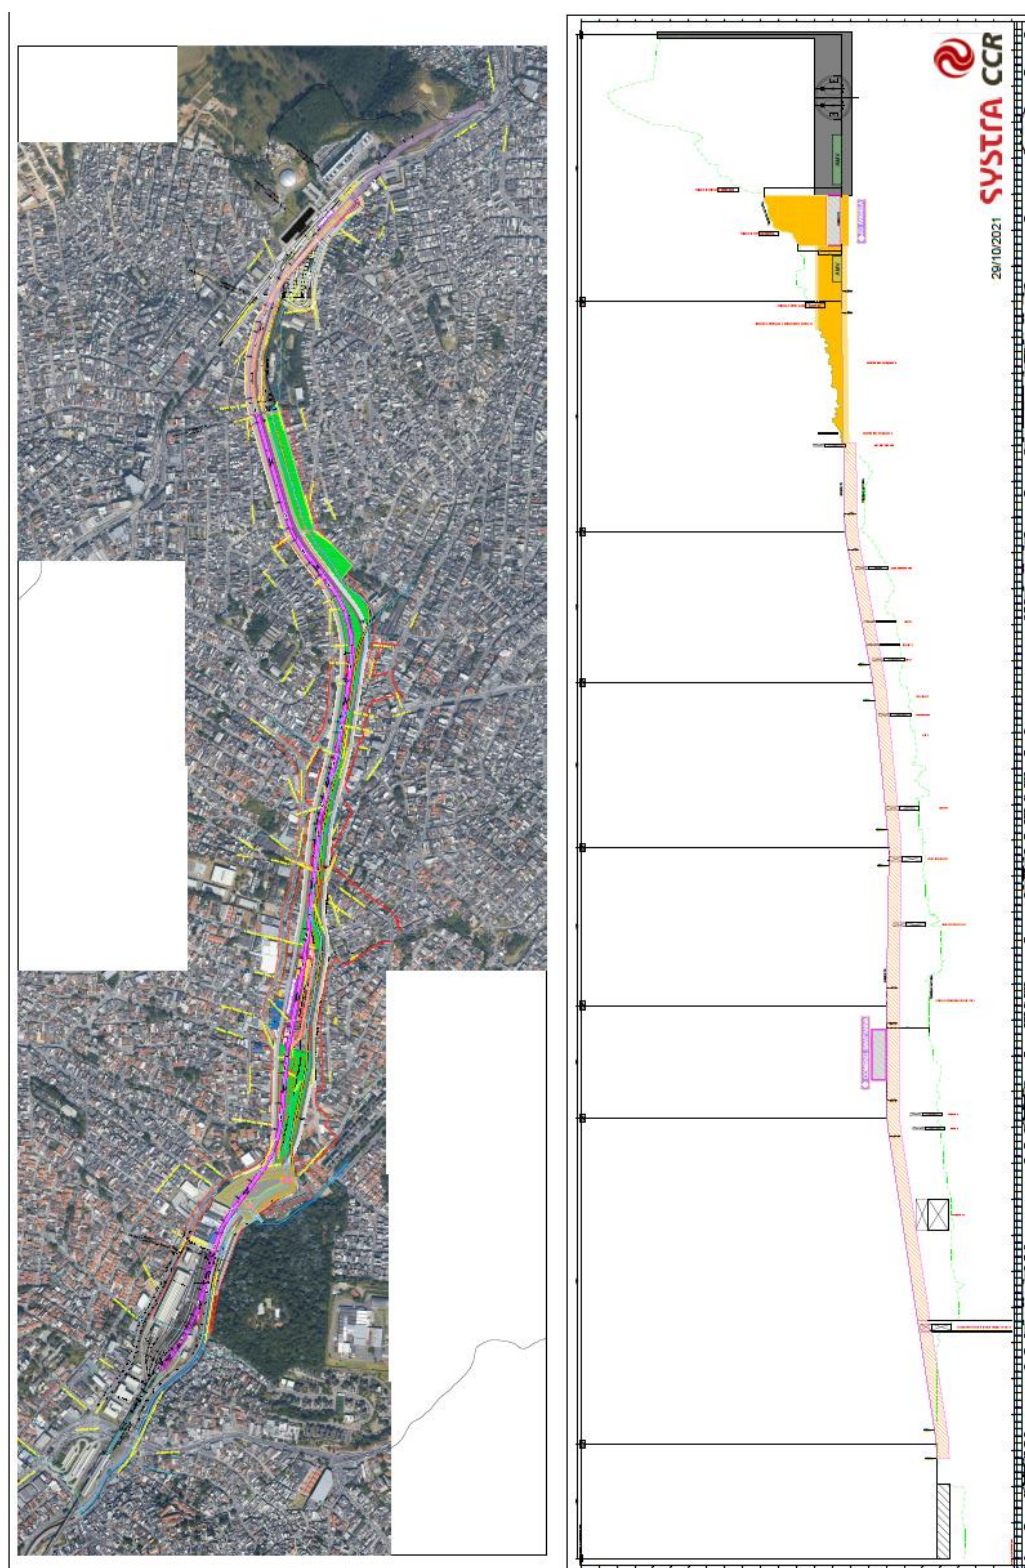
Planta e Perfil da “Alternativa 5C”, com o metrô no canteiro central da futura Av. Carlos Caldeira Filho (alternativa “B”)
